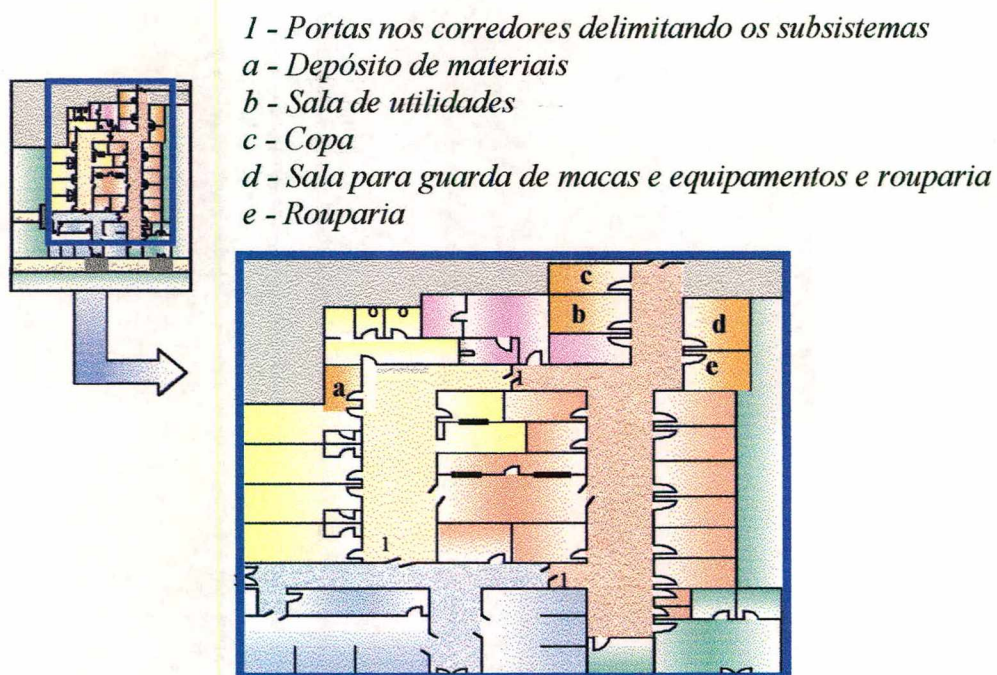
Vista parcial dos locais e espaços de trabalho após as alterações propostas, área correspondente ao subsistema 5.
